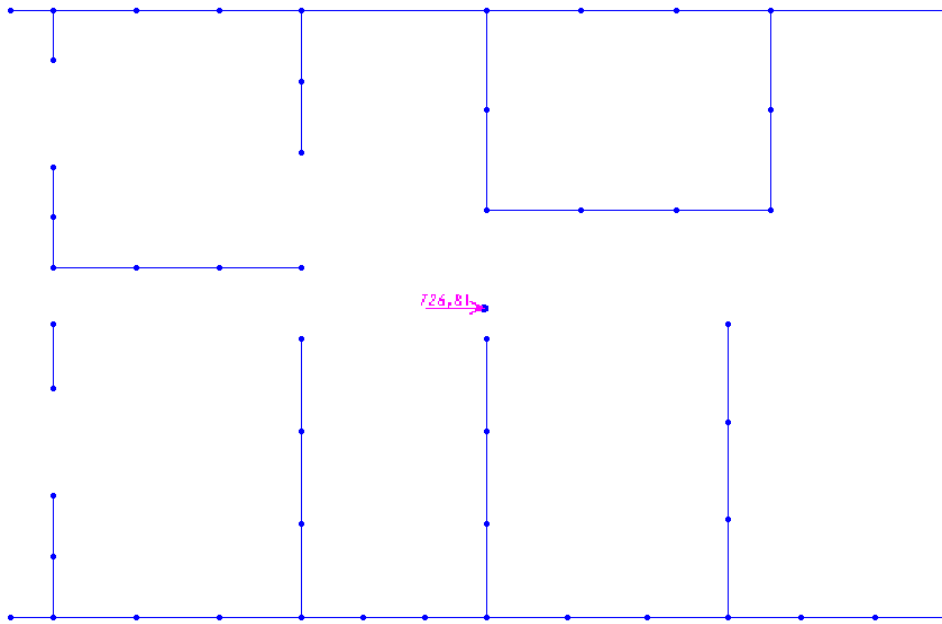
Vista en planta del modelo de SAP2000 para la casa 2
